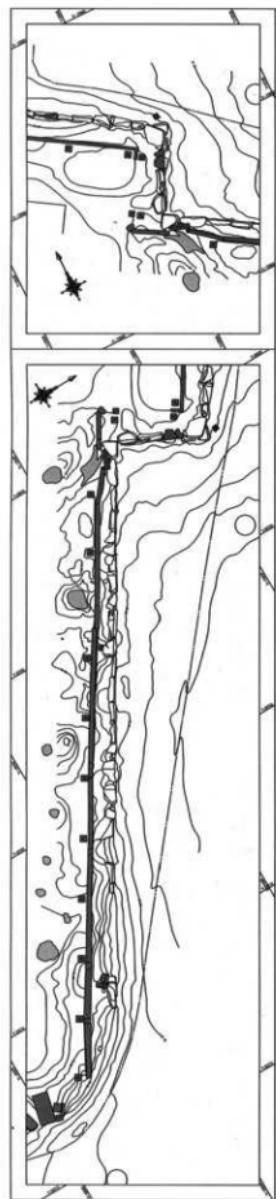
H25漢校弘道館跡橋測量調査 平面図・立面図・断面図
